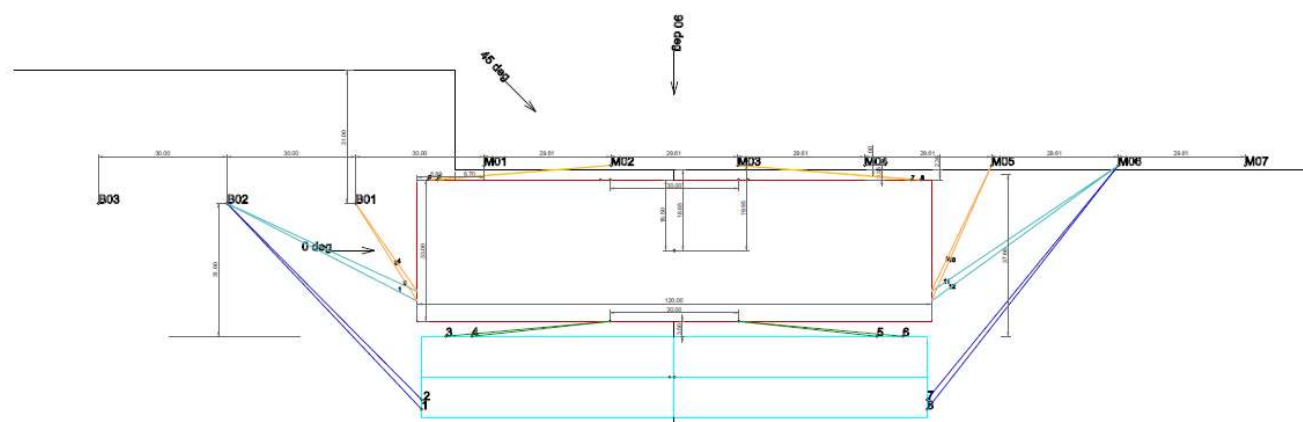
Layout sistema ormeggio FSRU e bettolina 7500 m3
